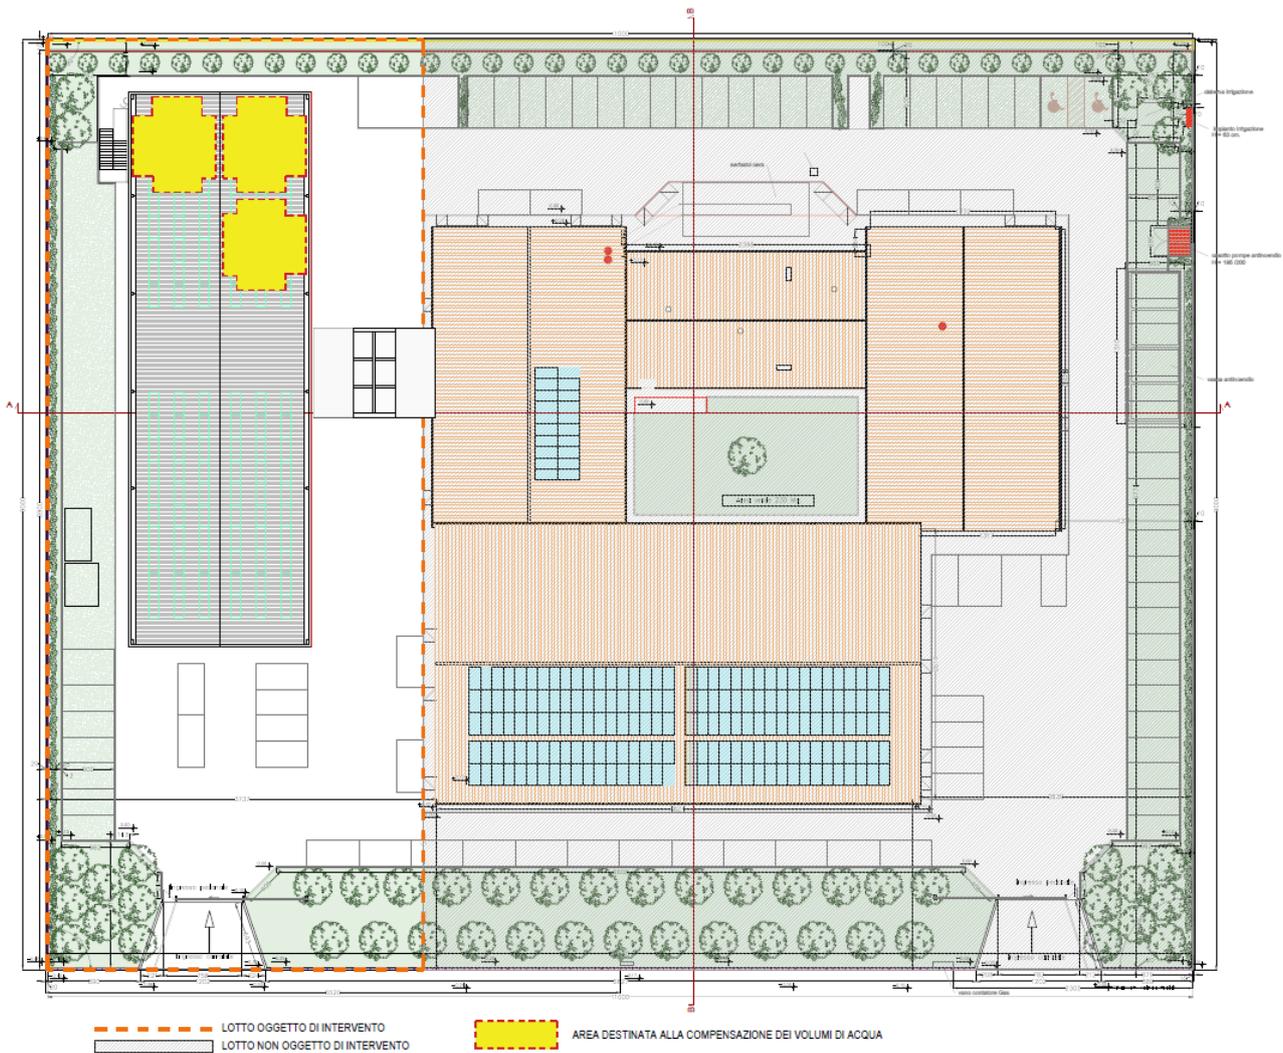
Schema planimetrico con individuazione della porzione in cui è prevista l'opera di compensazione
